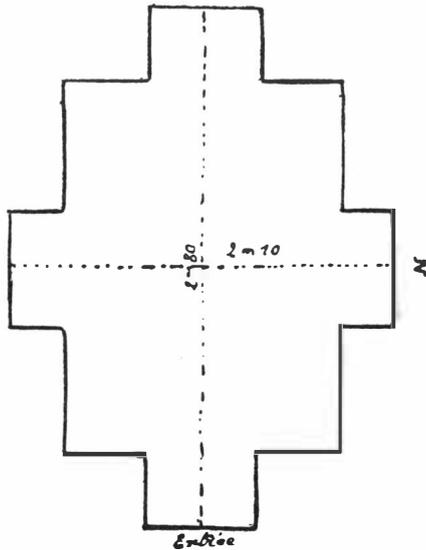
Plan d'un caveau romain en pierre. — Ath. (*Annales Soc. Arch. Bruxelles*, t. XVI, 1902, p. 26).
